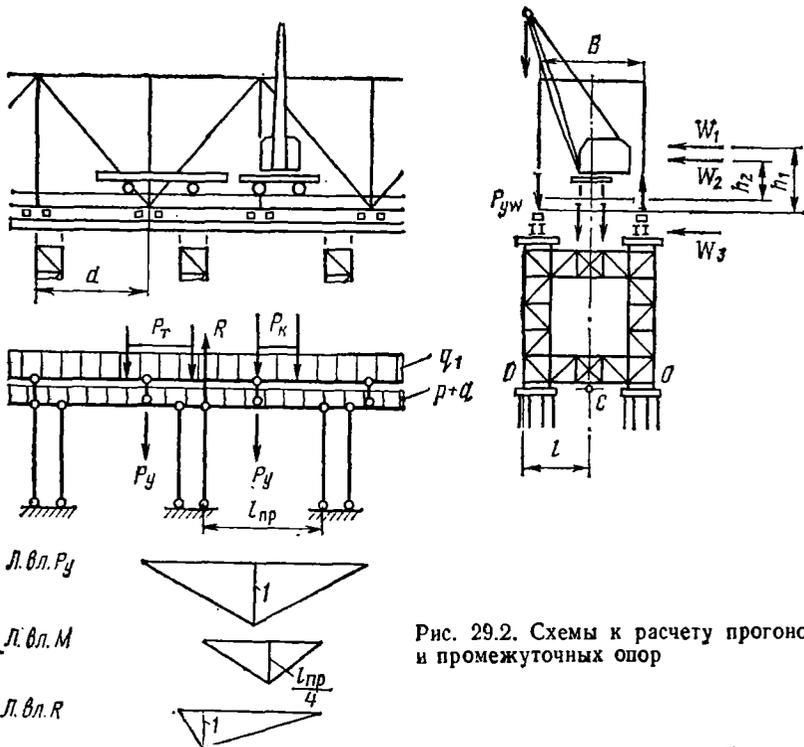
Схемы к расчету прогонов и промежуточных опор
